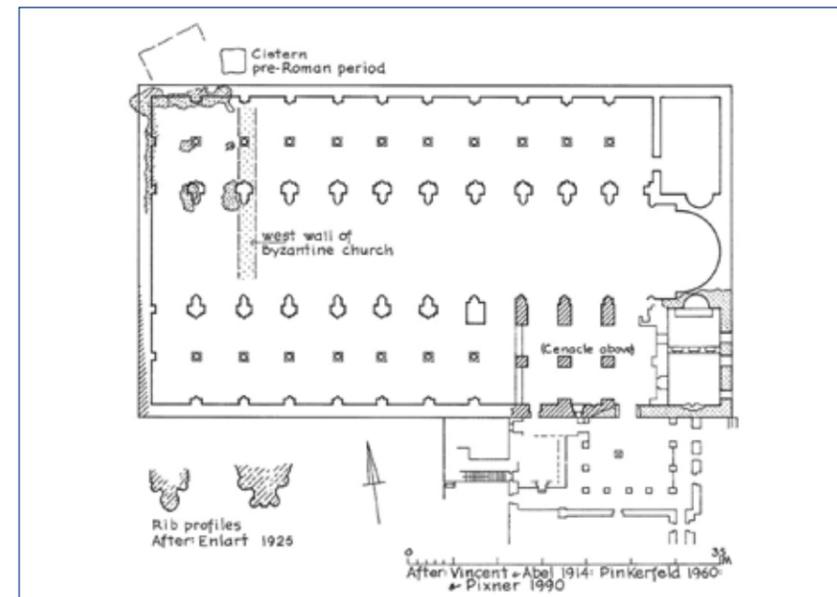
Zionskirche, Rekonstruktion des kreuzfahrerzeitlichen Grundrisses nach Denys Pringle
